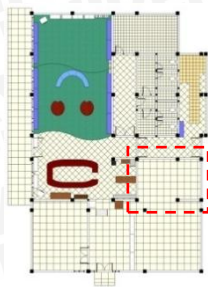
Hasil Desain Area Baca Santai Lantai 1
